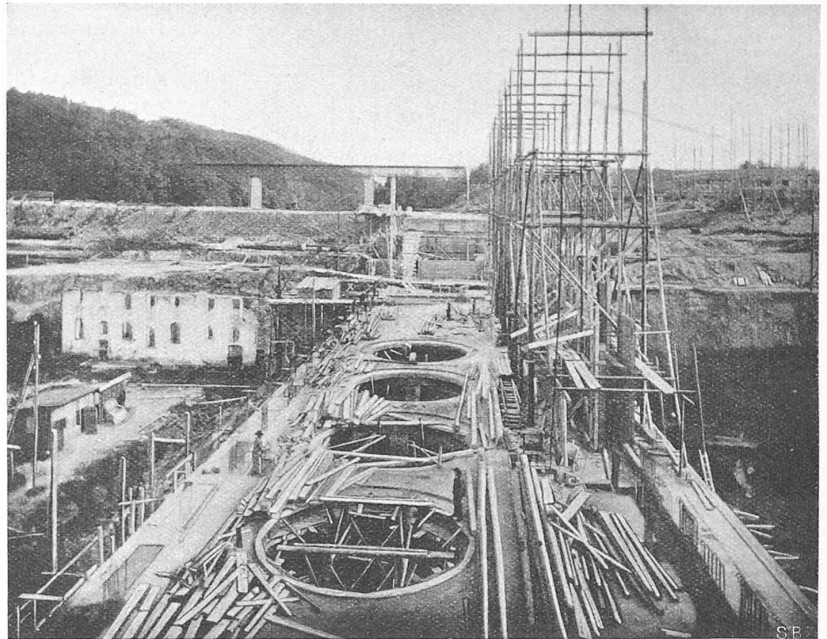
Öffnungen für die Generatoren im Maschinenhausboden. — 17. September 1918.
